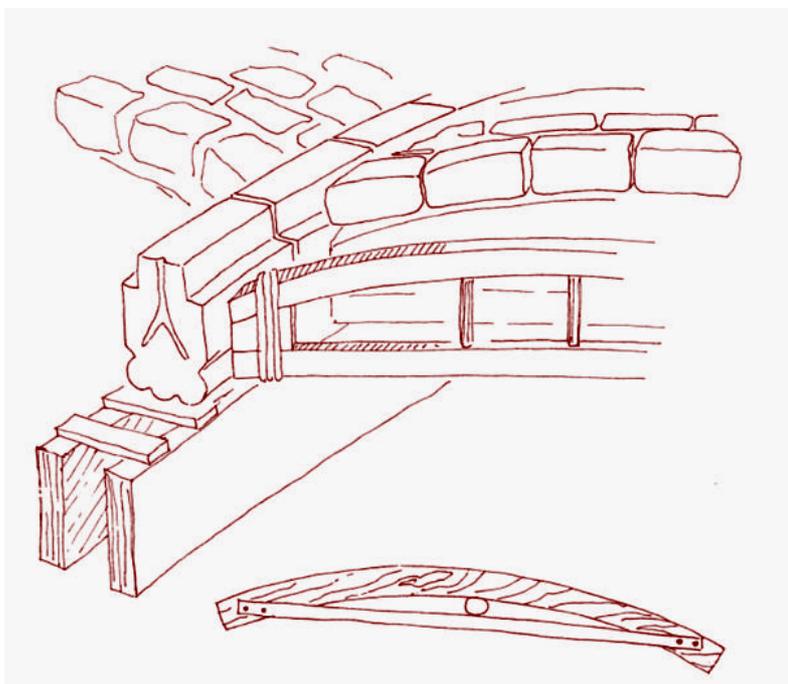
13.3 Cerchas utilizadas para las plementerías, según Fitchen.
